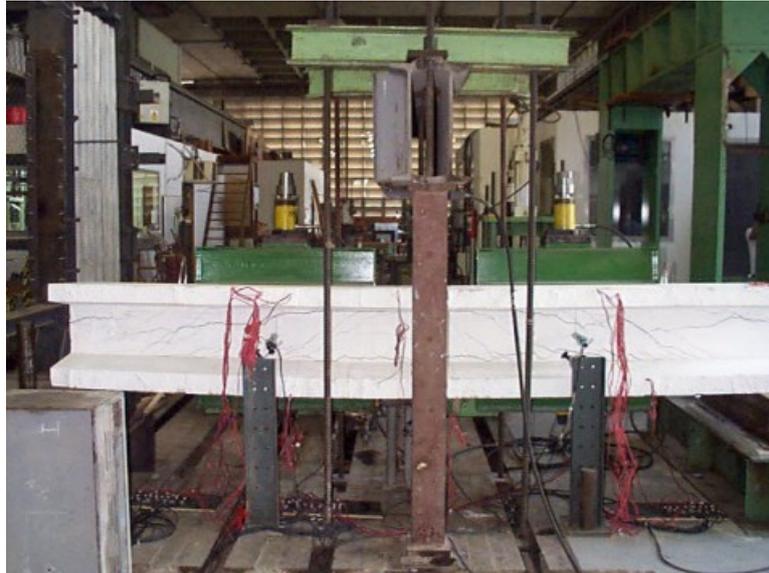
Fissuração indicativa do esquema biela-tirante
